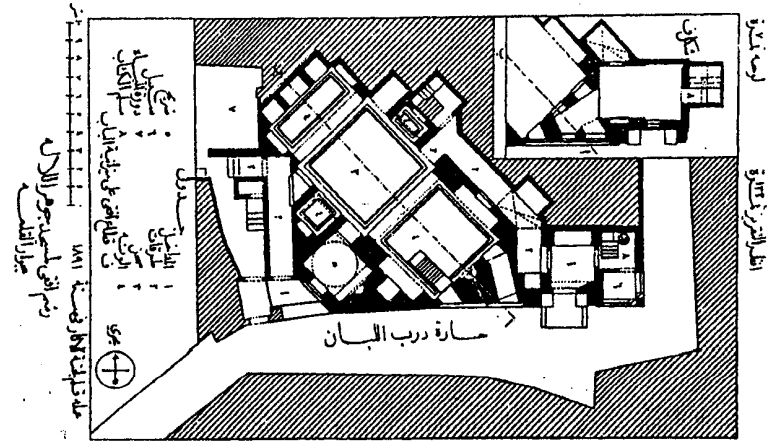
مسقط أفقي لمجمع السلطان قلاوون بالقاهرة (عن Creswell)
